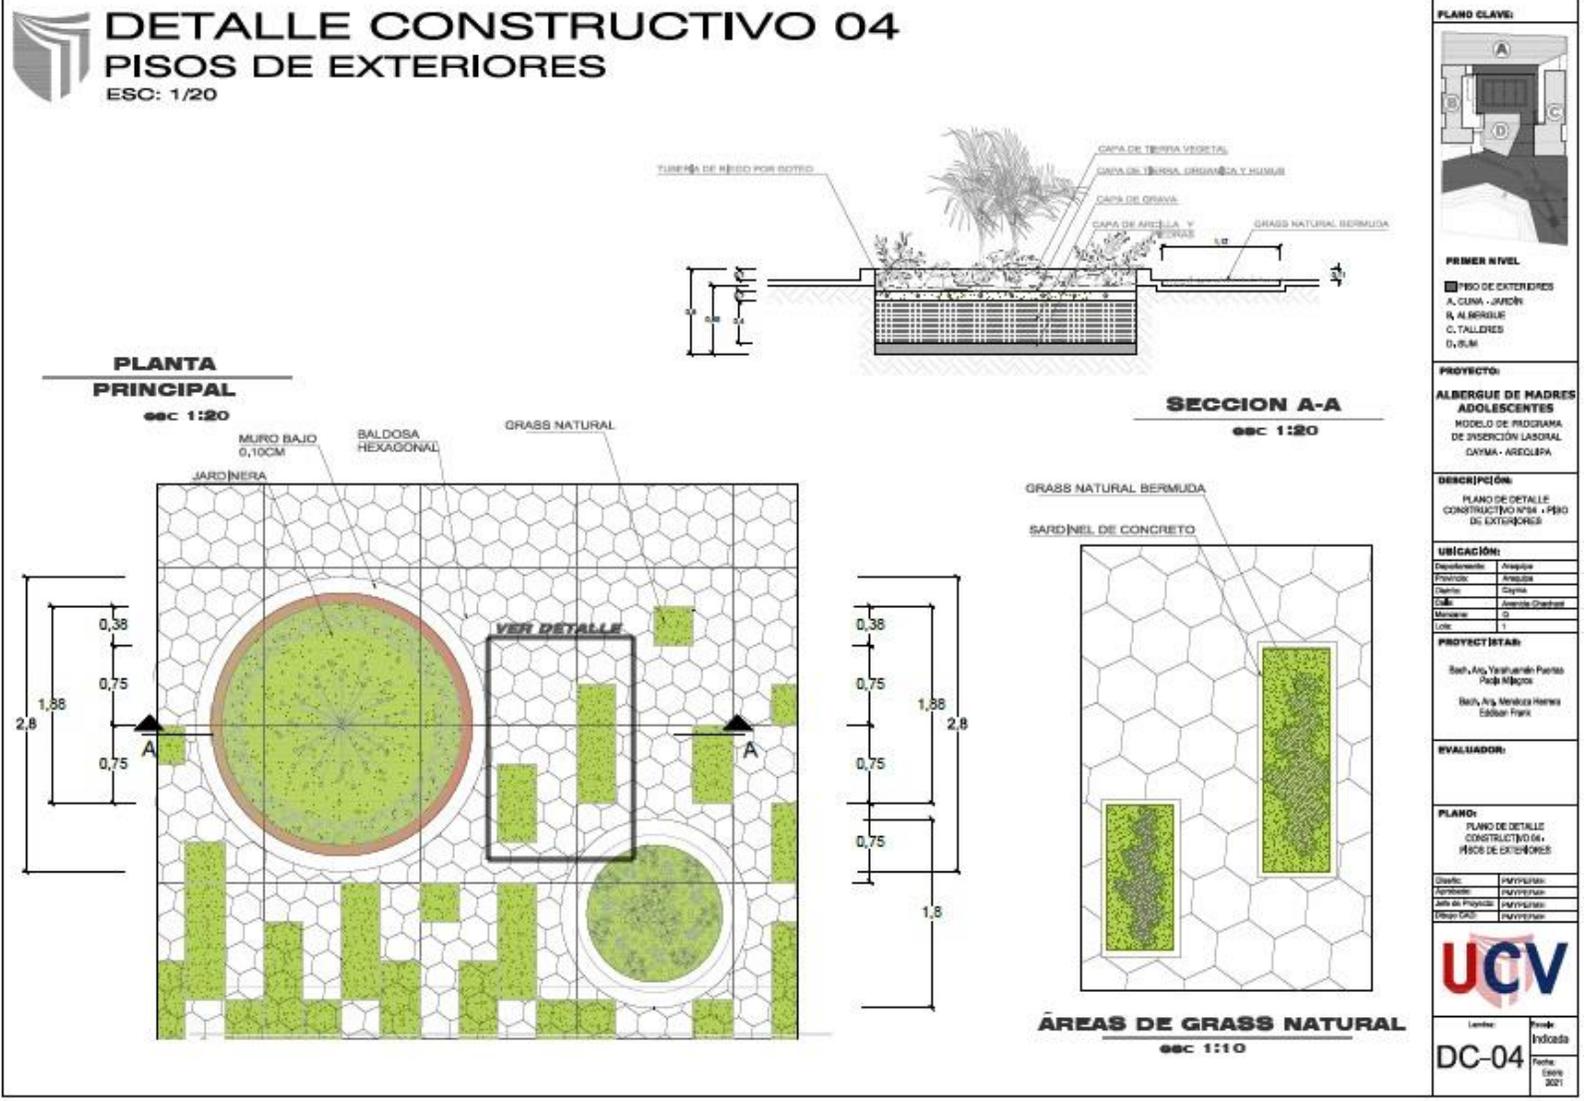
Detalle Constructivo 04 – Pisos de Exteriores DC-04.
